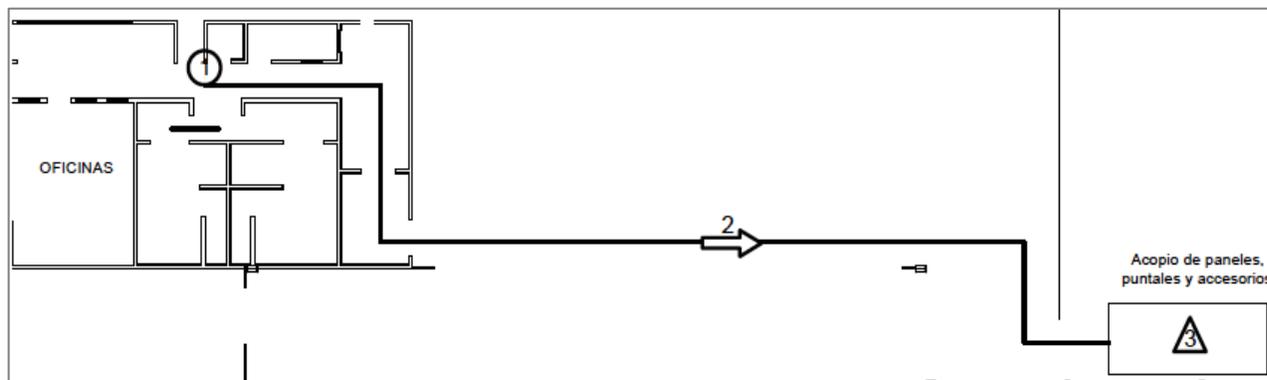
Diagrama de recorrido de muestra 1 de desencofrado de columnas rectangulares.
